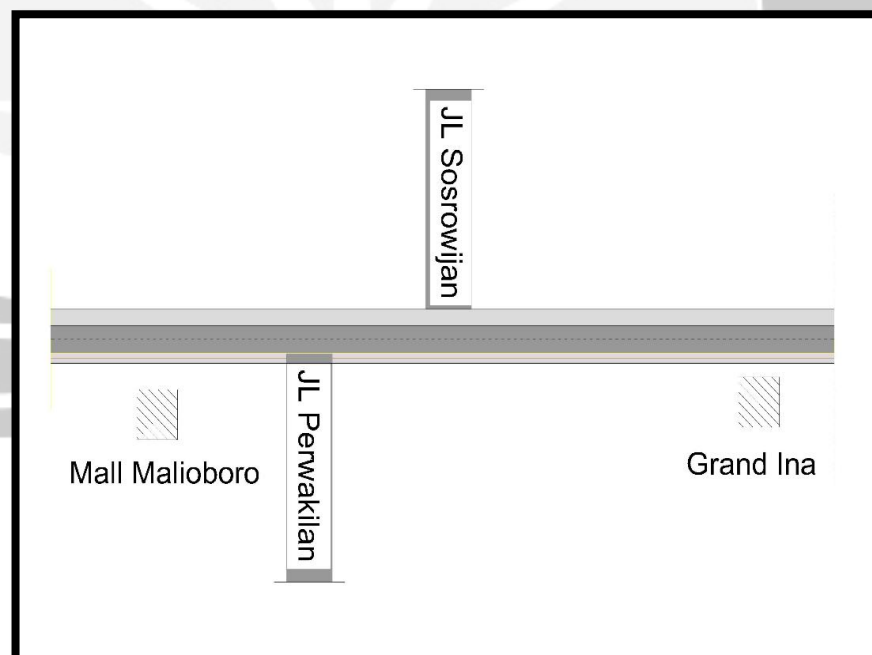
Detail ruas jalan pada Jalan Malioboro
